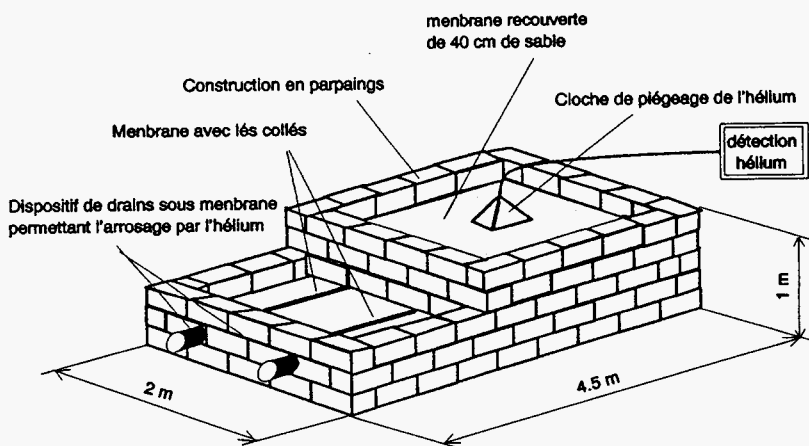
Pilote d'essai réhaussé par une couche sableuse drainante.
